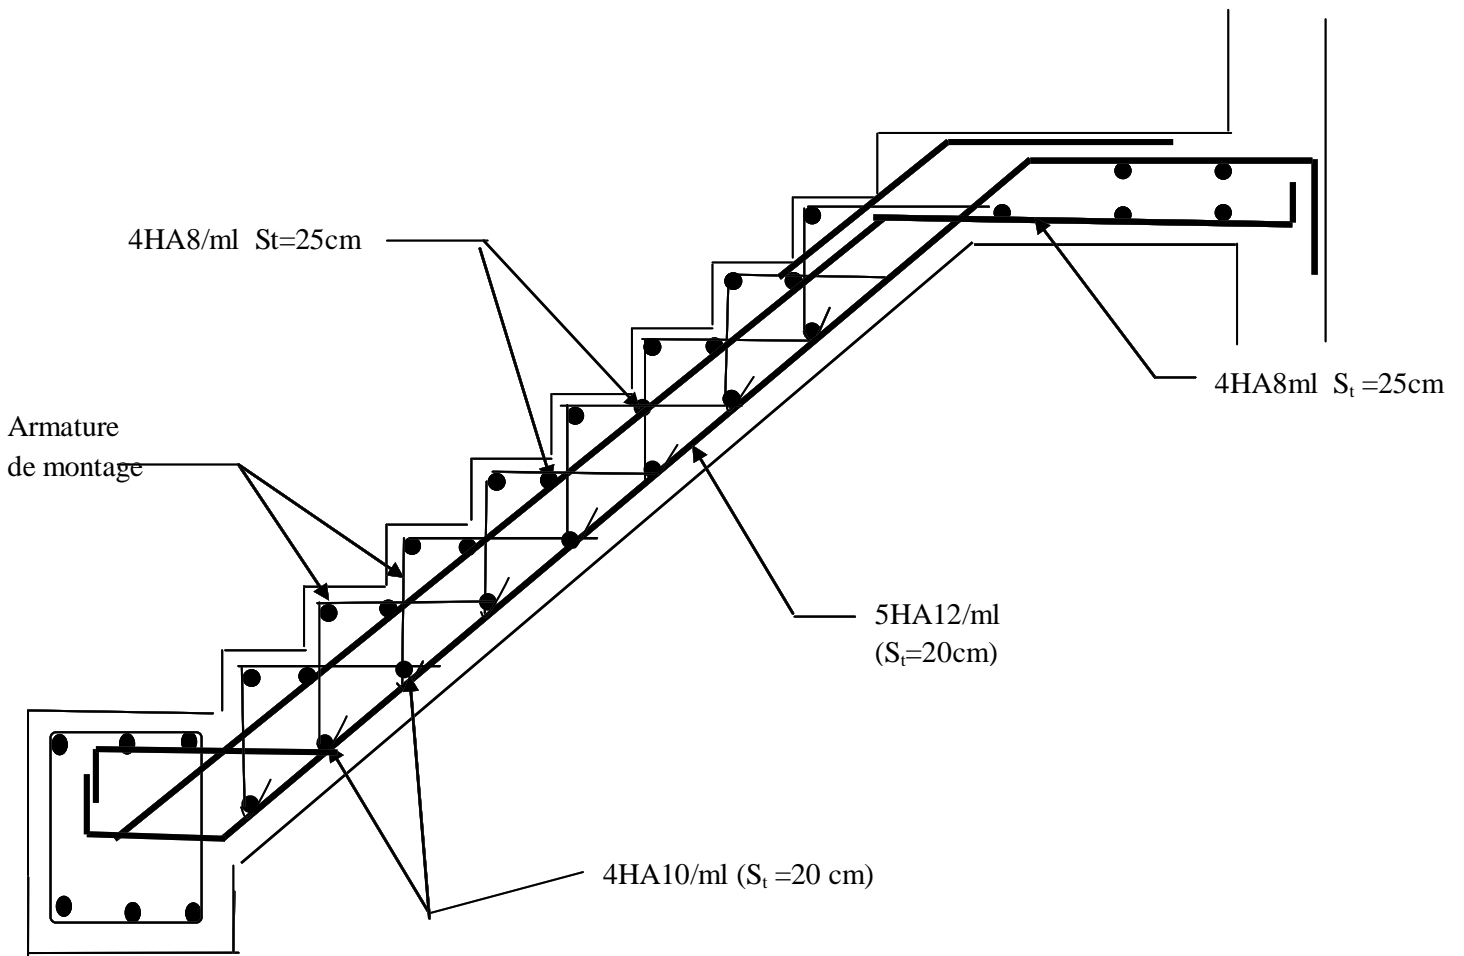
Schéma de ferrailage de l'escalier du plancher courant
